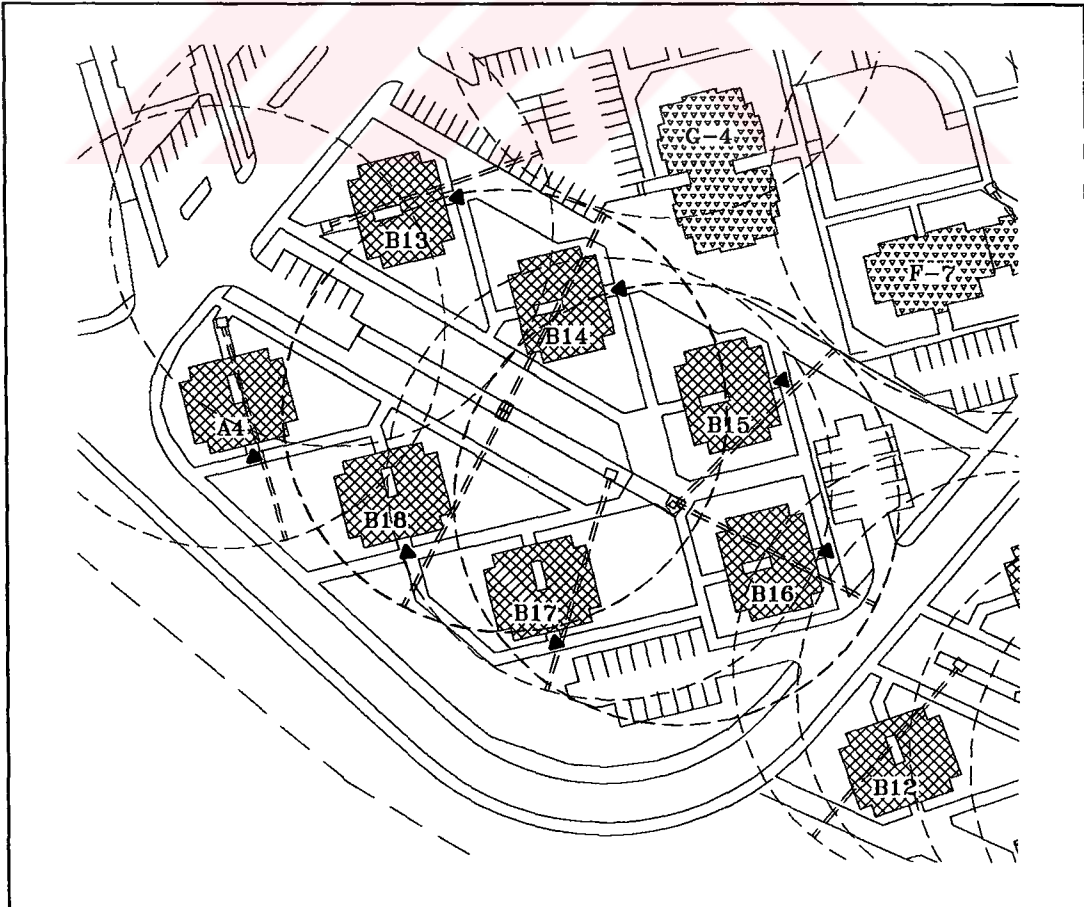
Eltes I. Etap 59 Nolu Ada Vaziyet Planı. [17]
